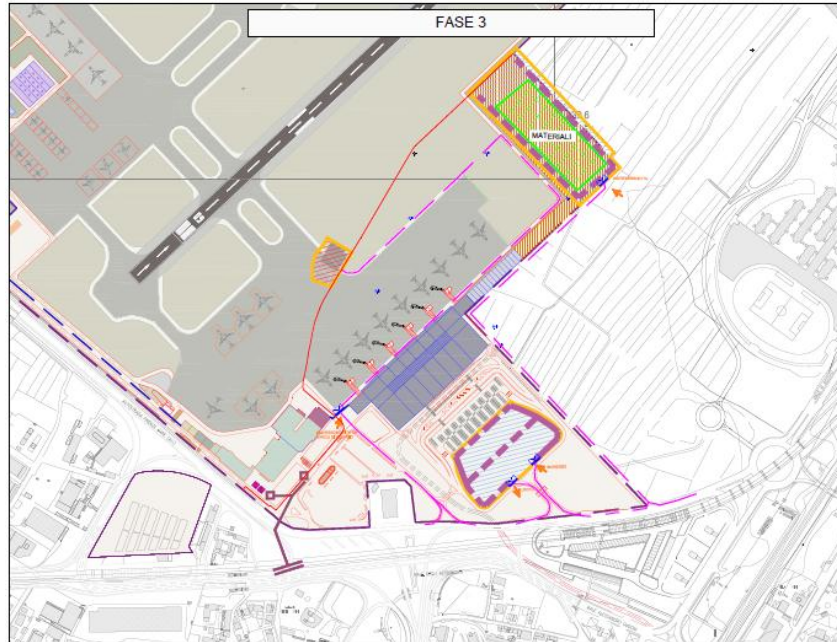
Cantierizzazione dell’Area Nuovo Terminal – Fase 3
